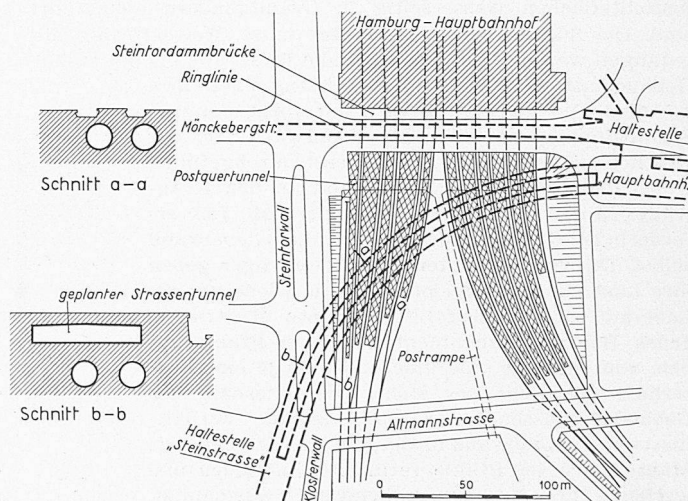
(rechts). Lageplan 1:4500 der Unterführung Hauptbahnhof
